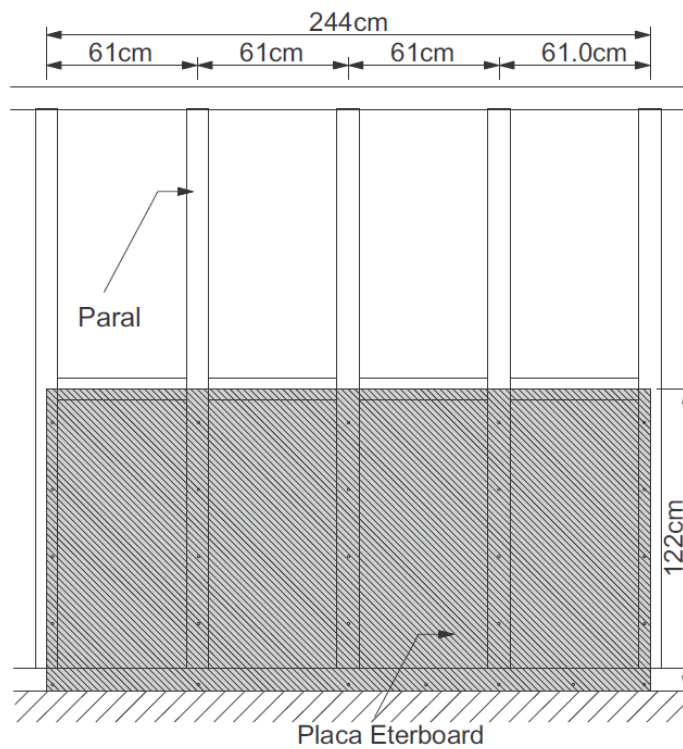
Separación para la subdivisión vertical de la estructura
